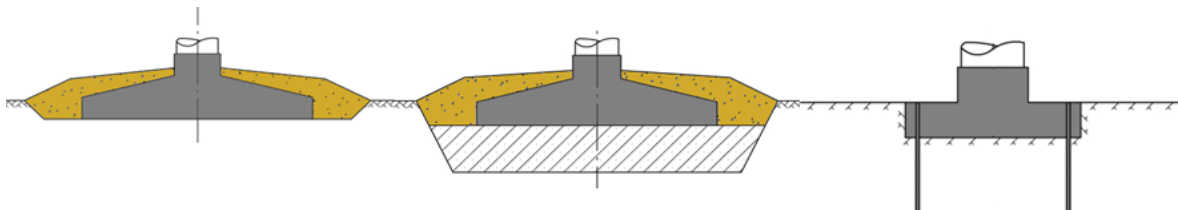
Principbilder över ett gravitationsfundament (till vänster) eller på en grund av armerad betong med massabyte (i mitten) samt en bergsförankrad grund av armerad betong (till höger).
